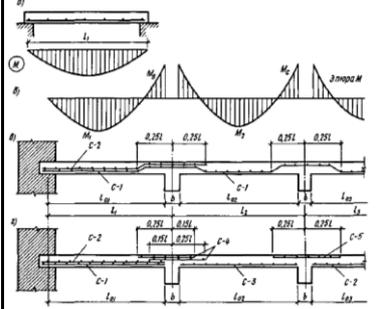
Армирование железобетонных плит: а — односторонней свободно лежащей на двух опорах; б — эпора изгибающих моментов; в — многосторонней — рулонными сетками с продольной рабочей арматурой; г — то же, с поперечной
